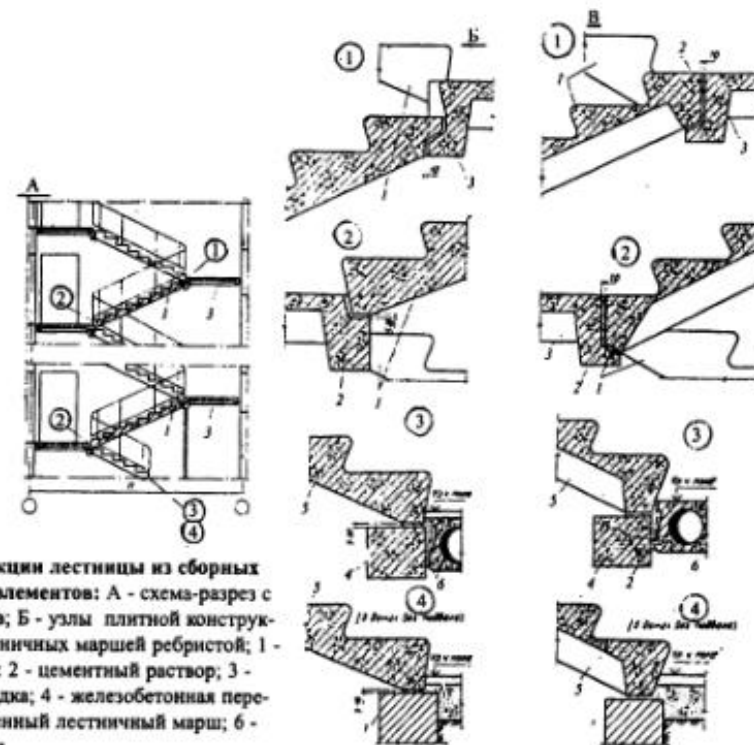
Конструкции лестницы из сборных железобетонных элементов: А - схема-разрез с маркировкой узлов; Б - узлы плитной конструкции; В - узлы лестничных маршей ребристой; 1 - лестничный марш; 2 - цементный раствор; 3 - лестничная площадка; 4 - железобетонная перемычка; 5 - укороченный лестничный марш; 6 - панель перекрытия
